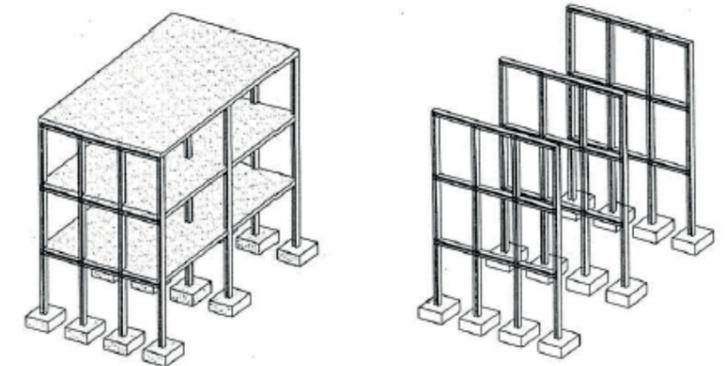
Sistema estructural de pórticos. Tomado de (UNED Metálicas, s.f.)
